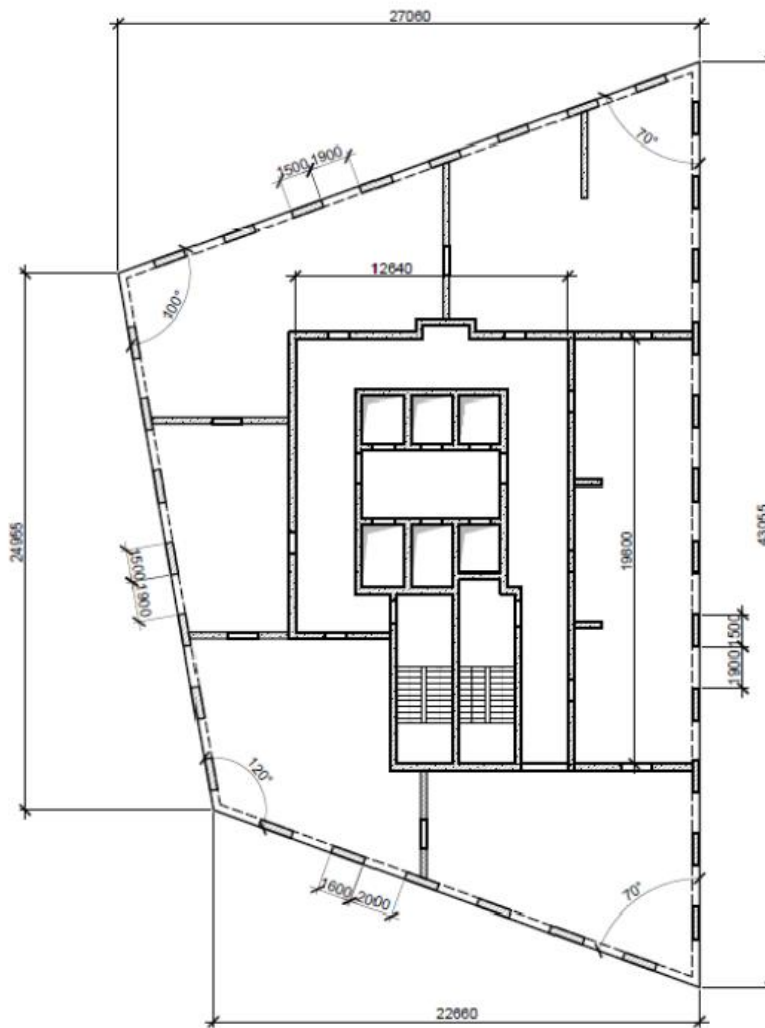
Конструкция типового этажа высотного здания из монолитного железобетона.
